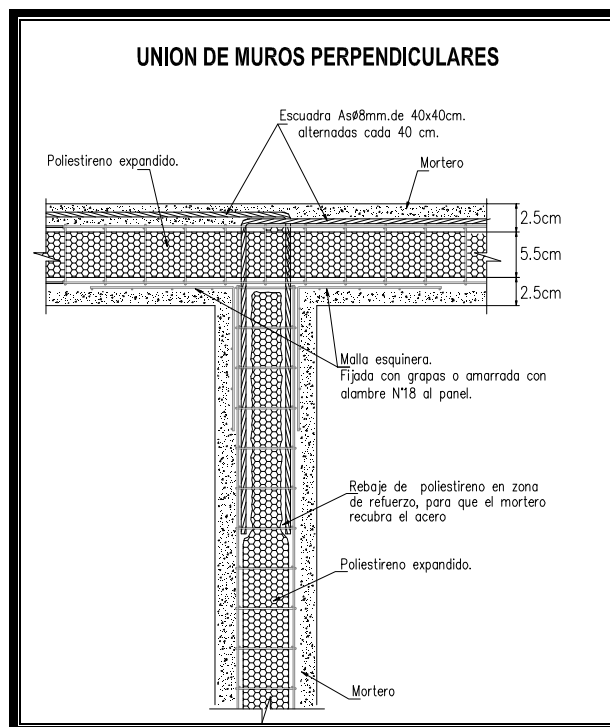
Detalle de armado de acero de refuerzo en muros perpendiculares
